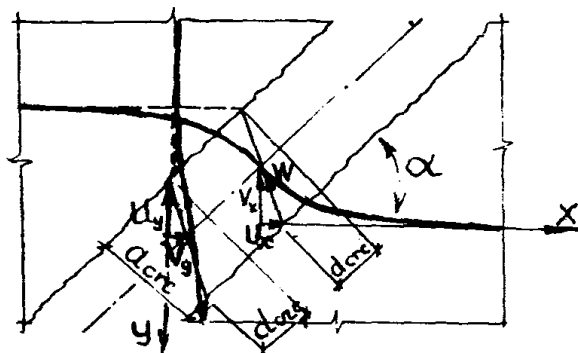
Схема перемещений арматурного стержня в трещине между берегами бетонной матрицы
